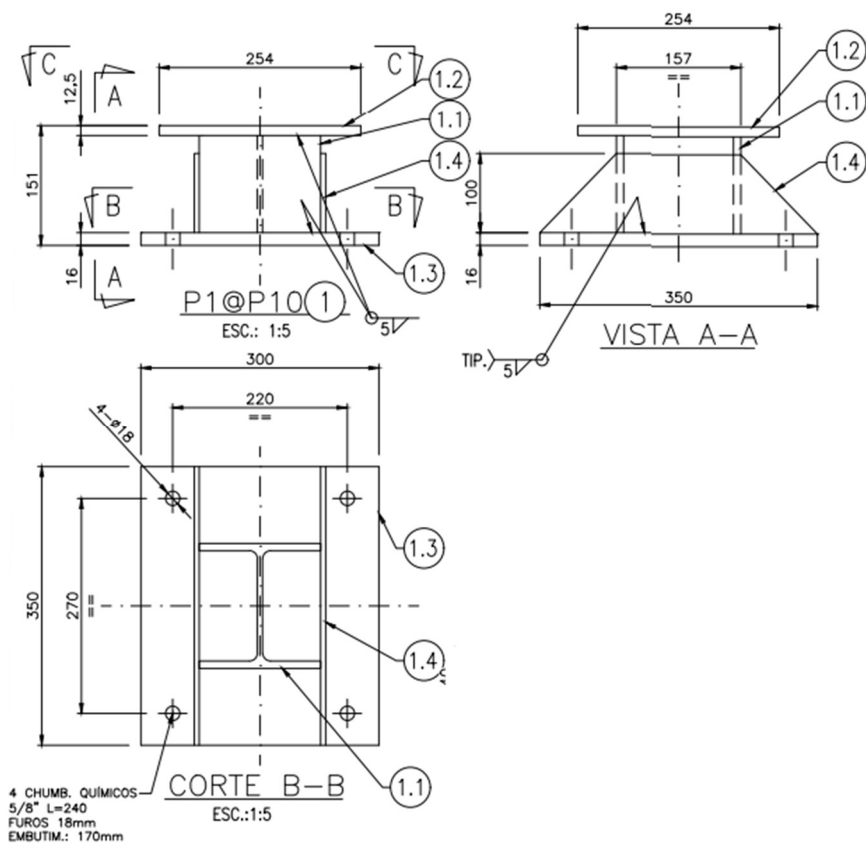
Exemplo de setorização em pilar retangular com Enrijecedores
